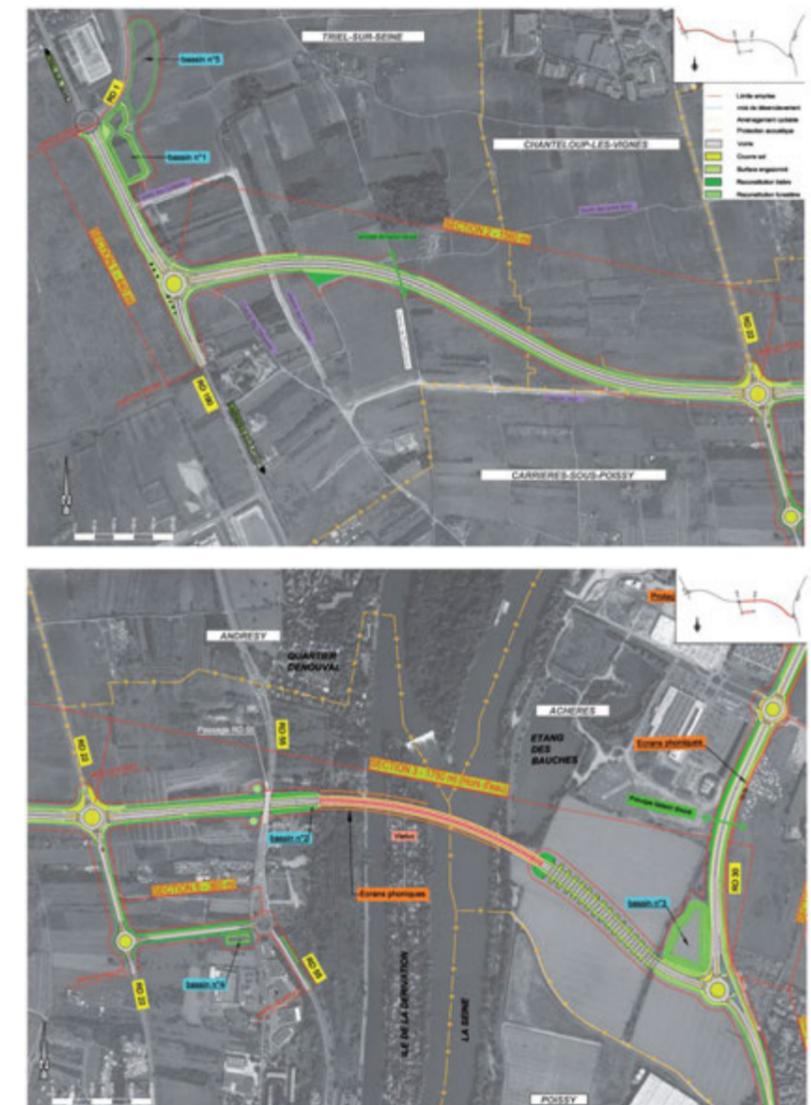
Plan Général des Travaux de la liaison RD30 – RD190
